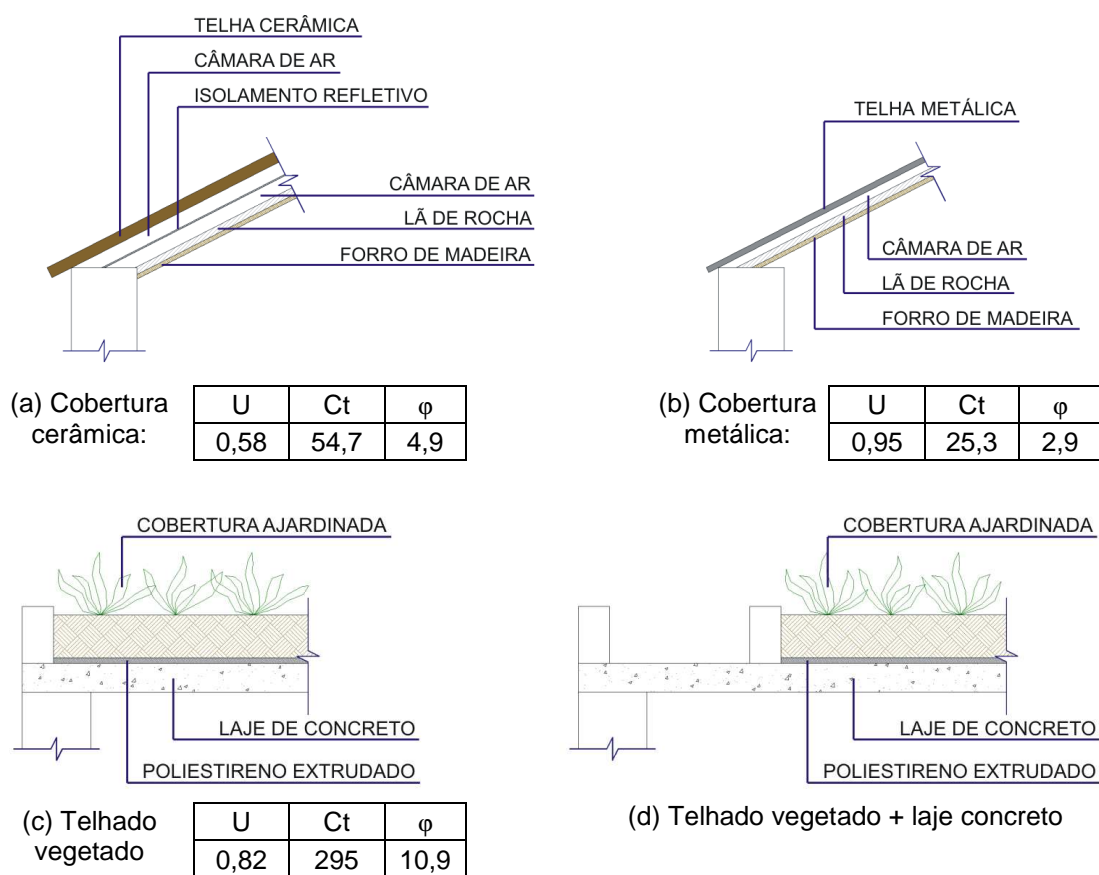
Esquema dos tipos de cobertura do modelo de calibração: telha cerâmica (a), telha metálica (b), teto jardim (c), teto jardim + laje de concreto (d).
